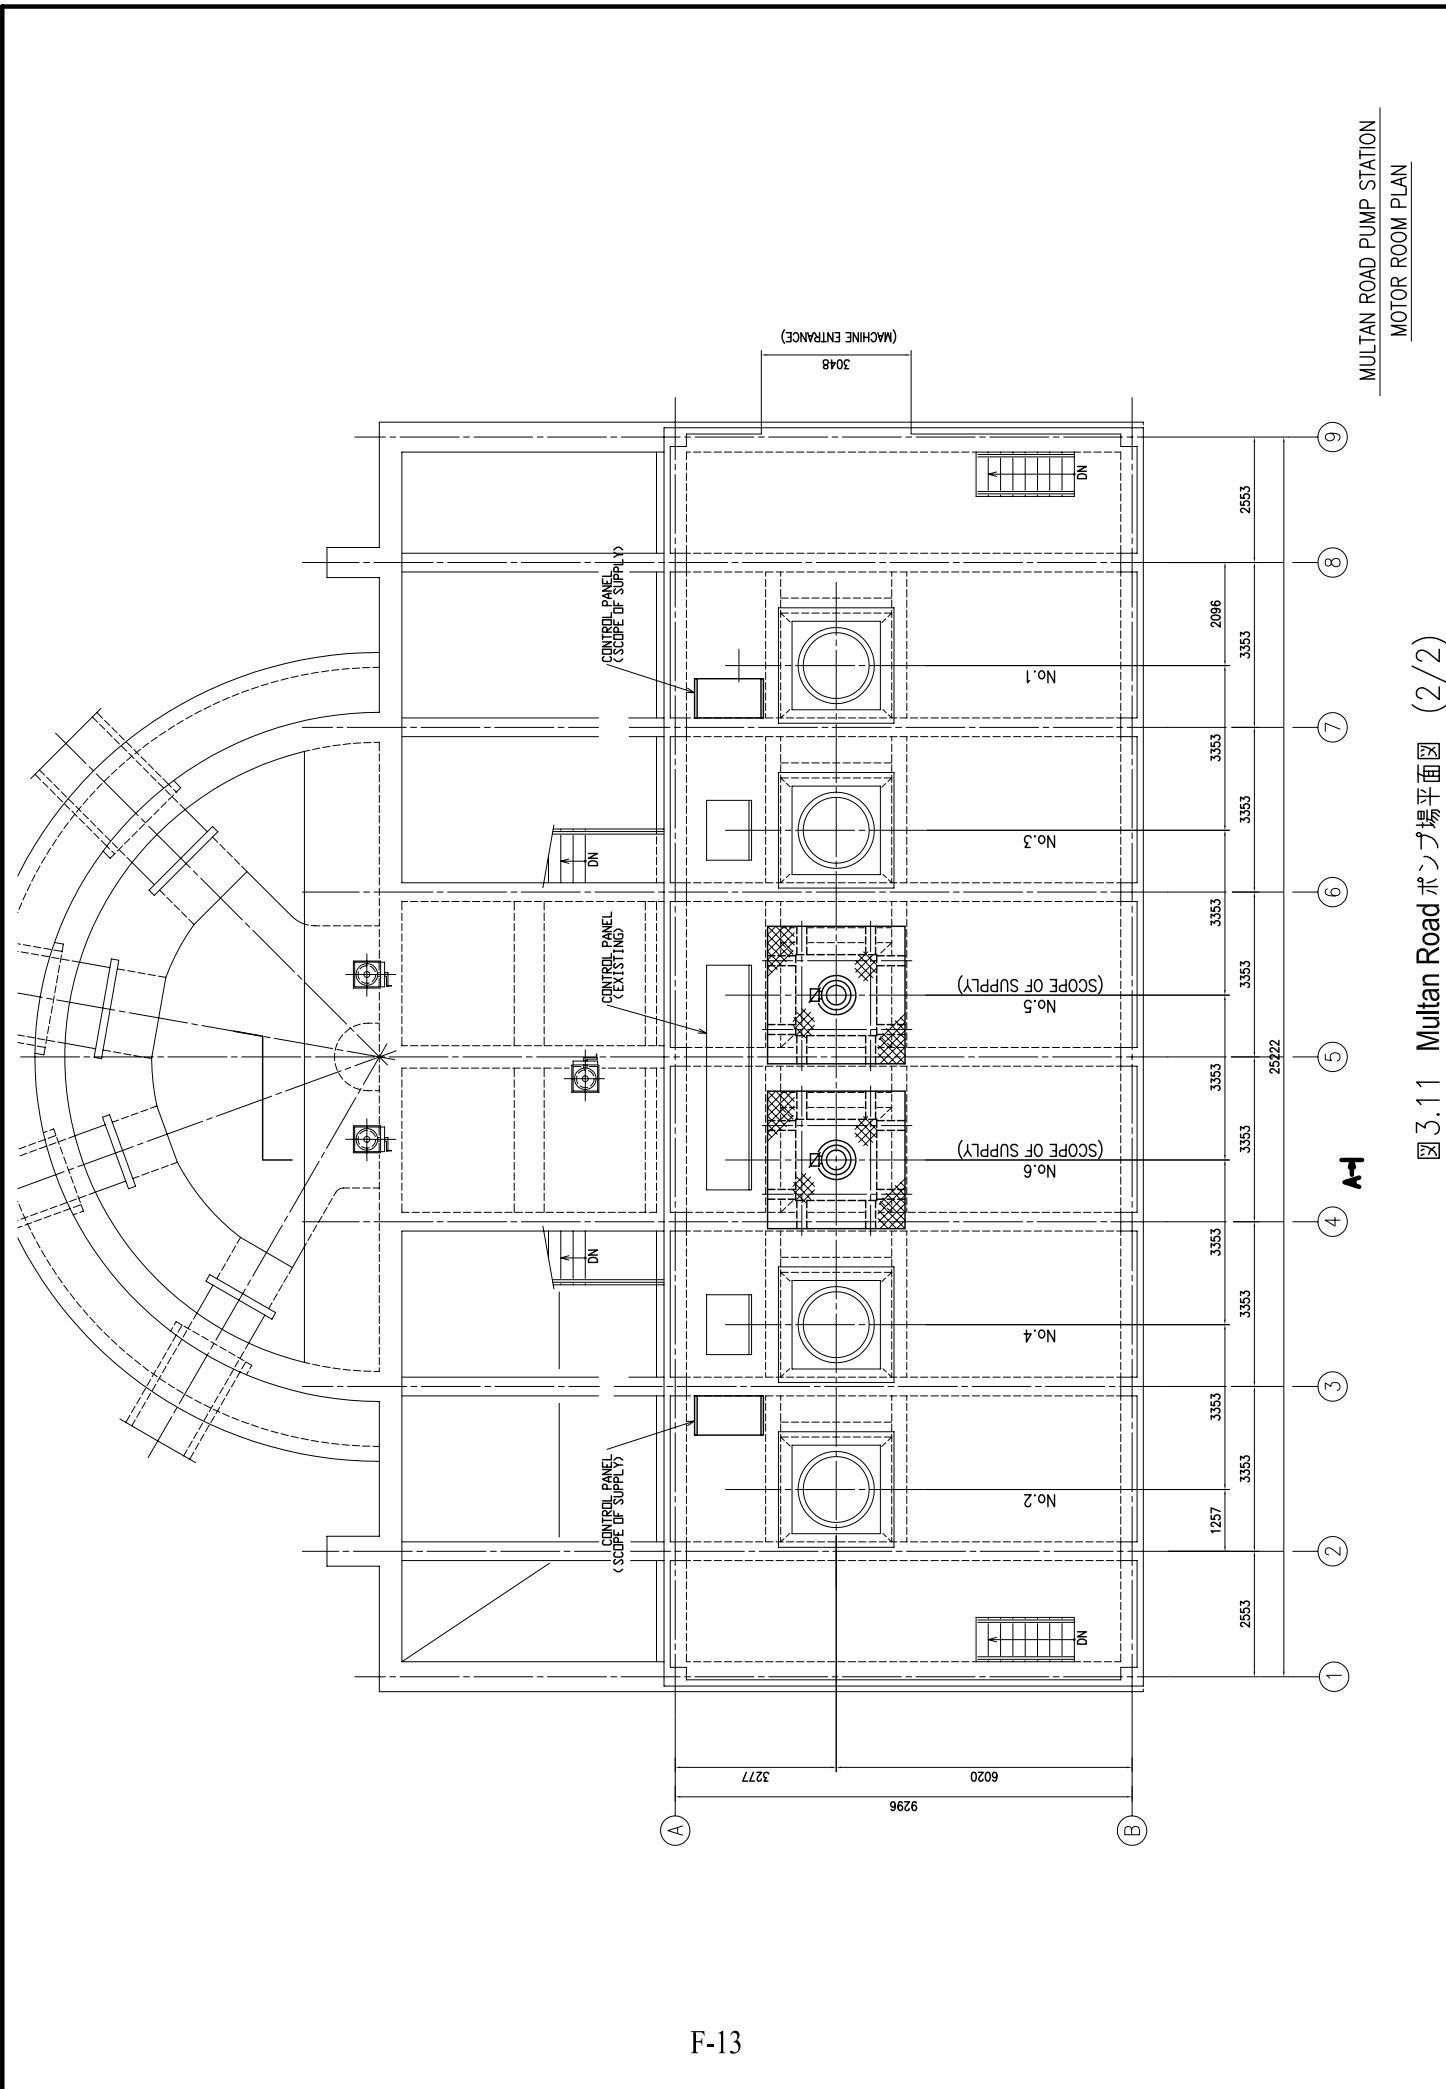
Multan Road ポンプ場平面図 (2/2)
